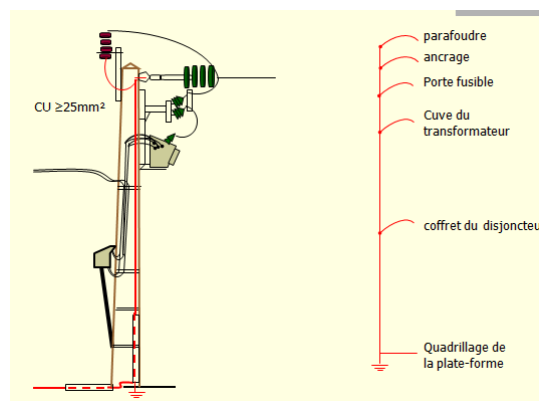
différentes liaisons à la terre d'un poste sur poteau [6]
